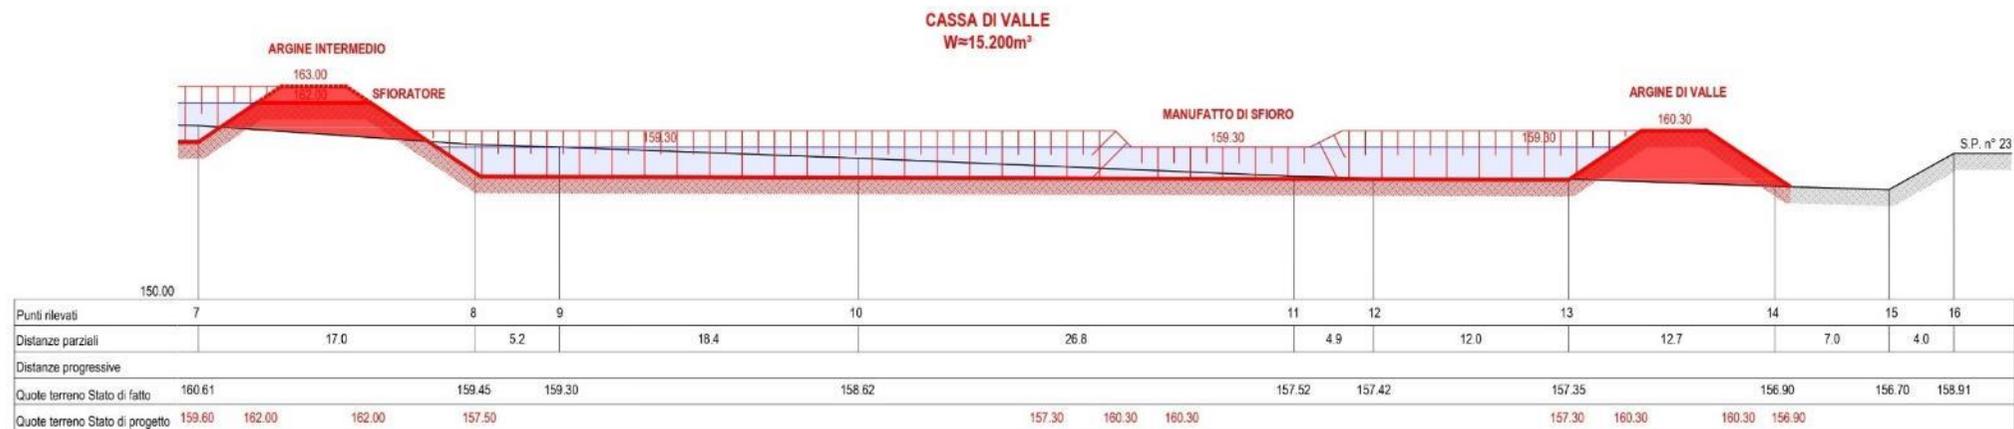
RIO ENZOLA, CASSA DI LAMINAZIONE DI VALLE: PROFILO LONGITUDINALE
